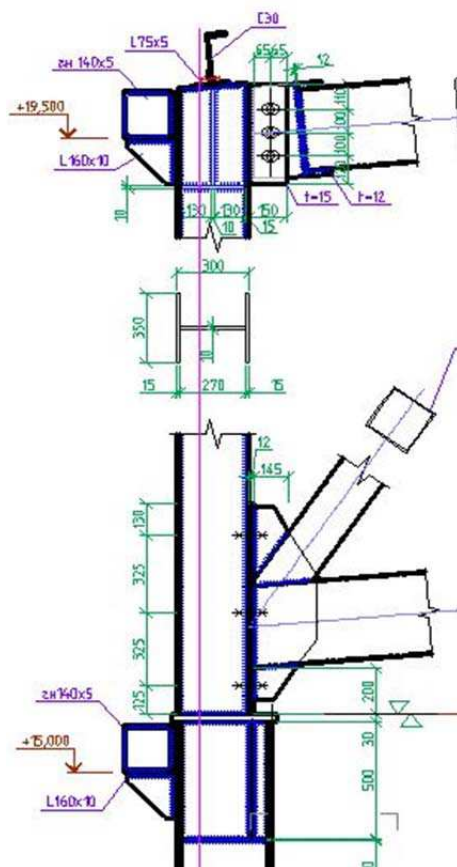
Узел сопряжения поперечной фермы с колонной
